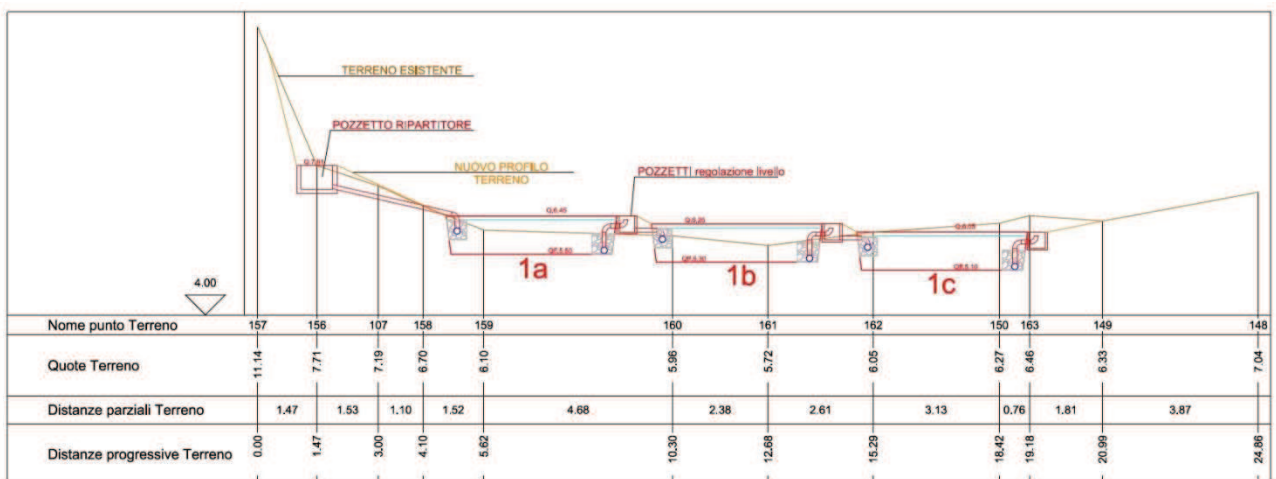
Sezione C-C' 1:100; (fonte: Parco dell'Adamello)
